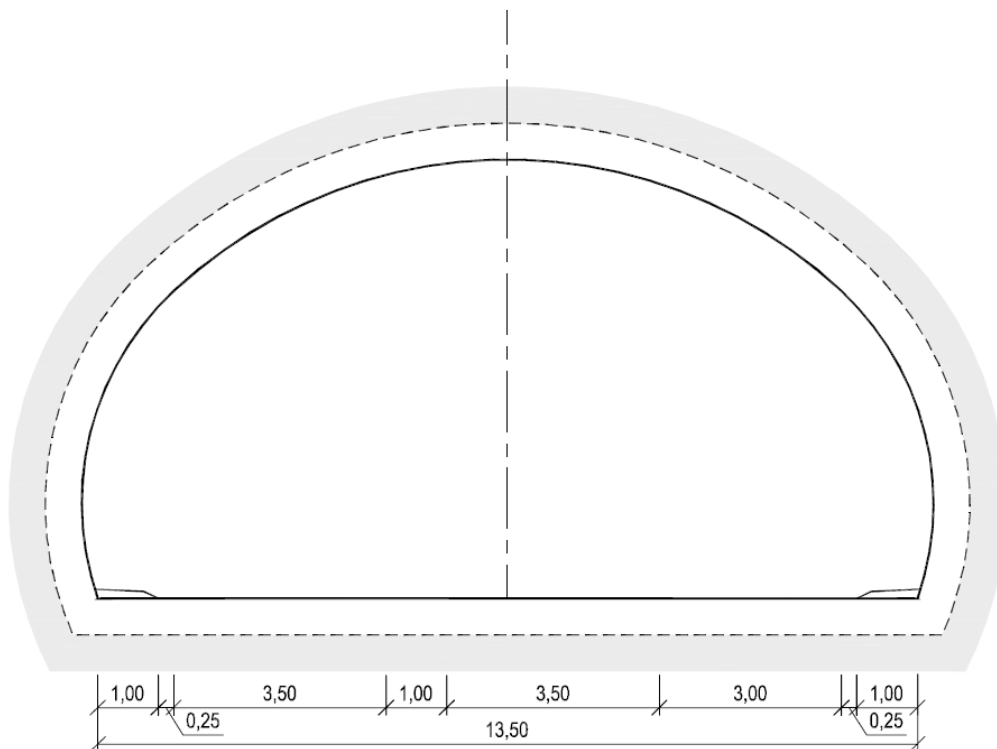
Tunnelprofil T12,5 (mål i m)
